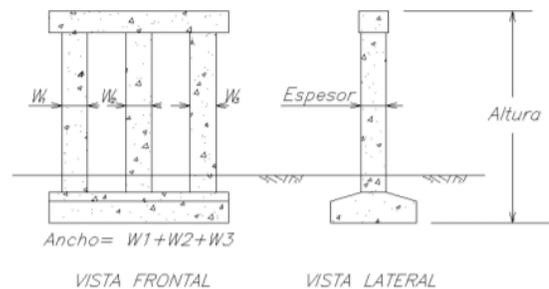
Pila tipo columna múltiple. Fuente: MOPT (2007).
